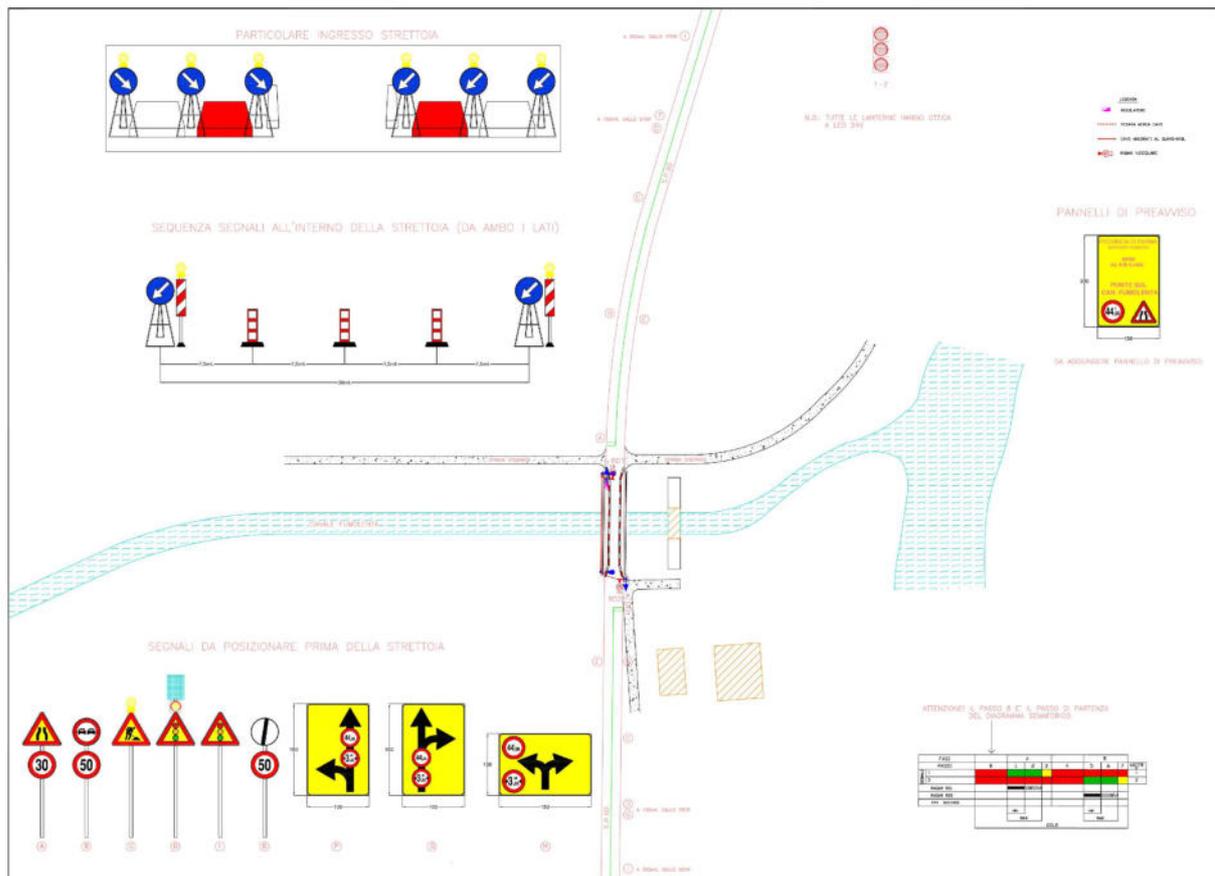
TAV.1: PLANIMETRIA INTERVENTO DEL PONTE SUL CANALE FUMOLENTA - SP60 DI SORBOLO - COENZO
